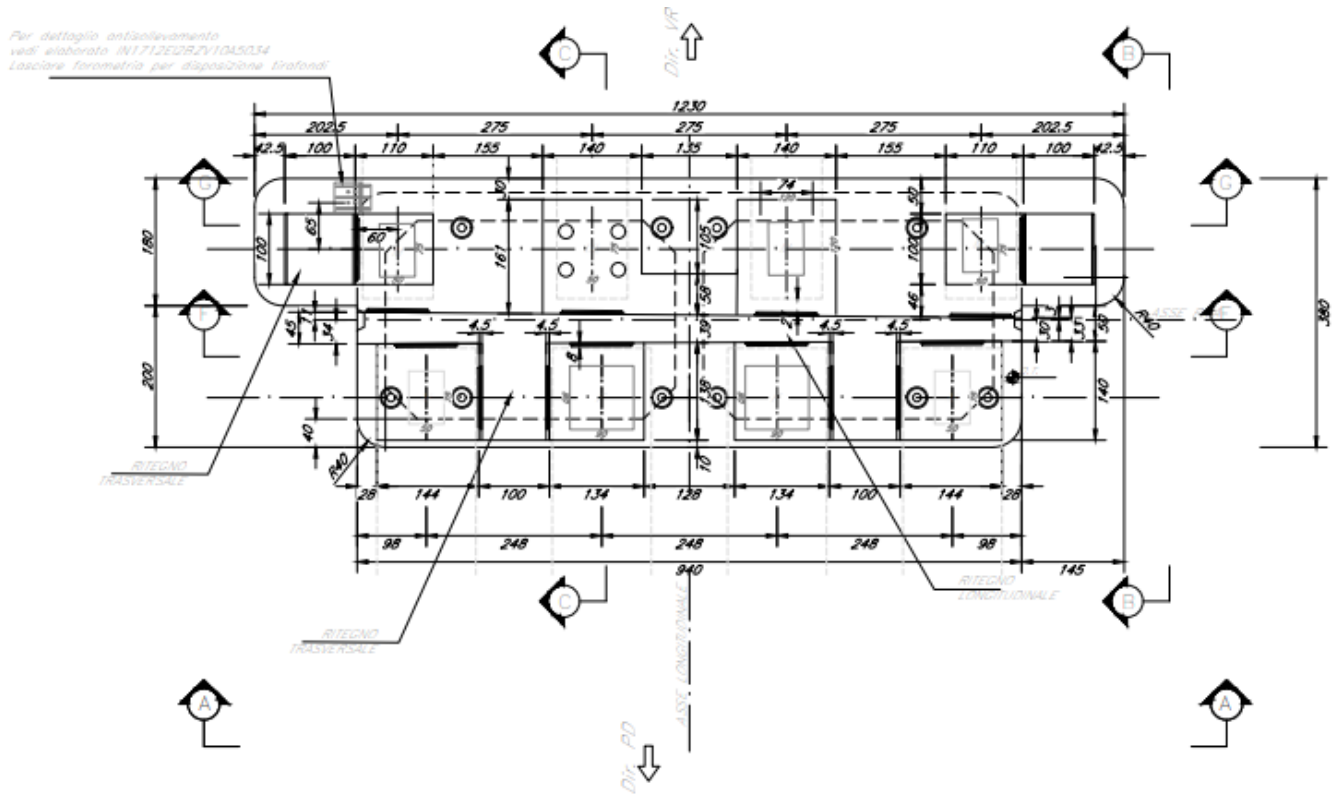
Sezioni e pianta pulvino (Allineamento fisso lato impalcato in Misto)
